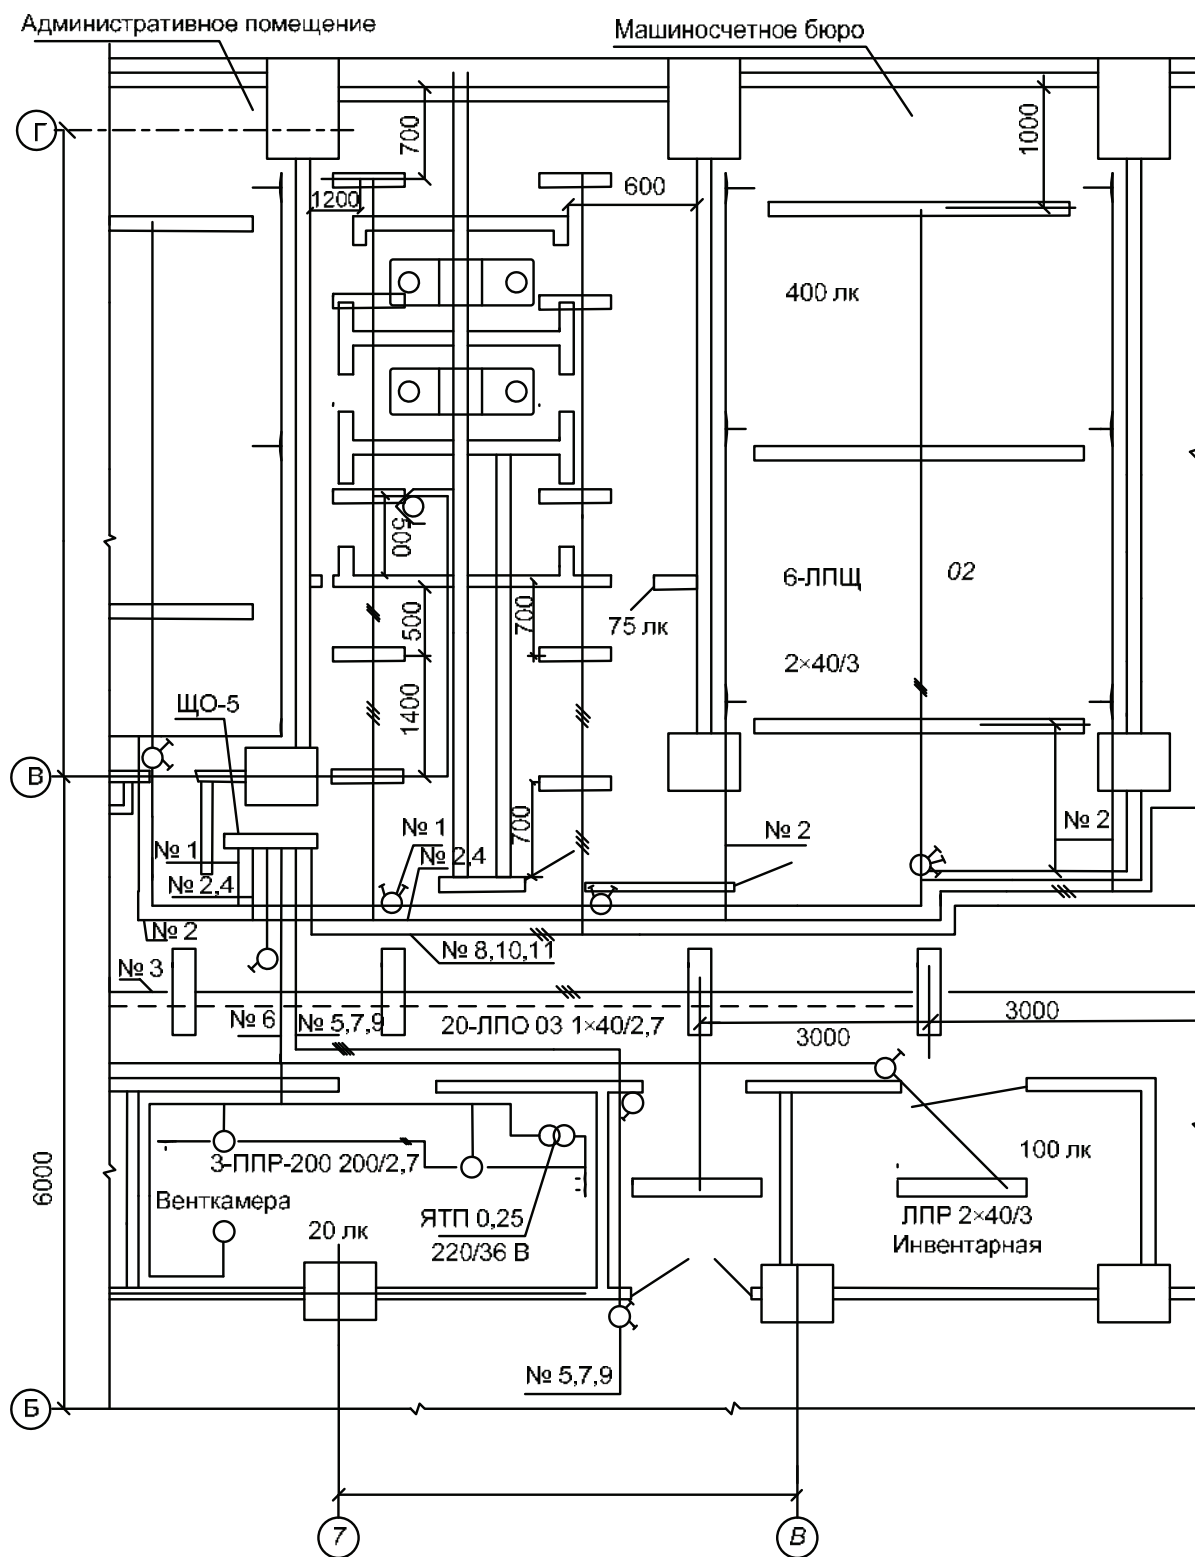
План расположения электрооборудования и проводки для общественного здания
